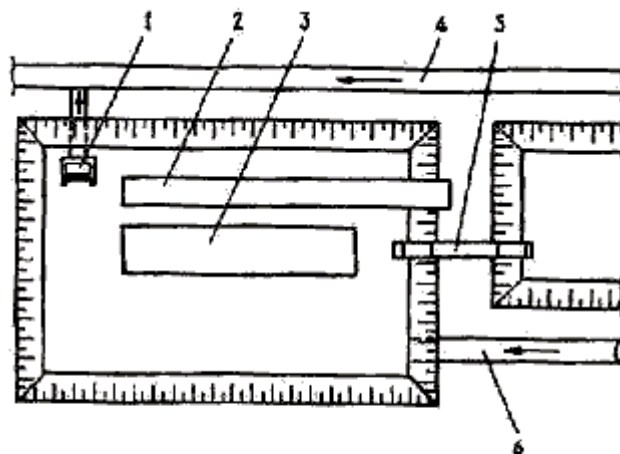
Схема обустройства земляного садка для выращивания сеголеток осетровых рыб (стрелками показано направление тока воды): 1 - сбросное устройство; 2 - понтон; 3 - донная площадка для кормов из бетонных плит; 4 - водосбросной канал; 5 - сифон; 6 - водоподающий канал
